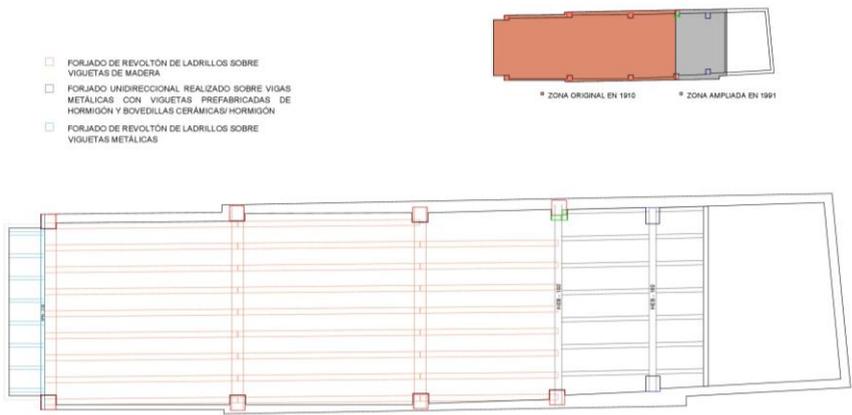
Plano de ampliación de forjado planta primera. 2018 Fuente: Propia
